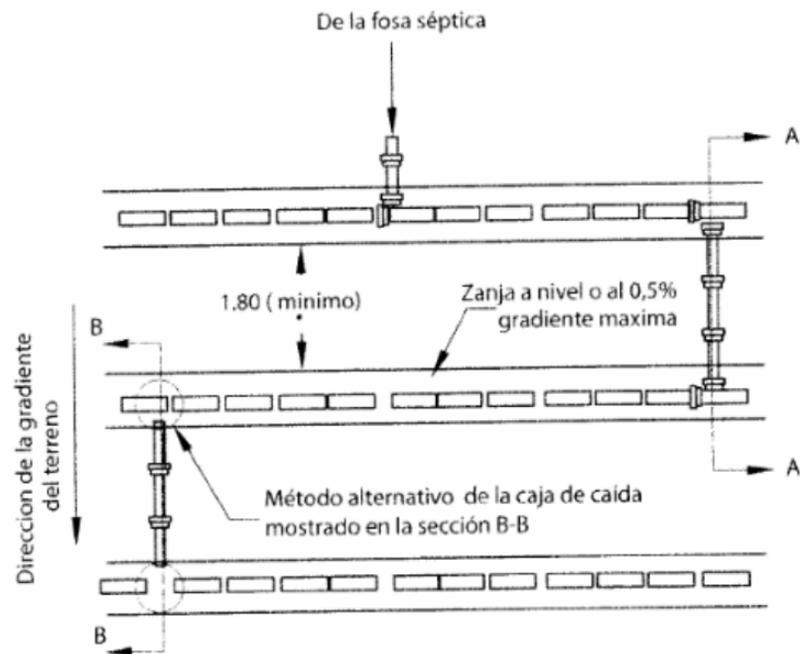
Figura D. Detalle constructivo de zanja de infiltración en terrenos inclinados
